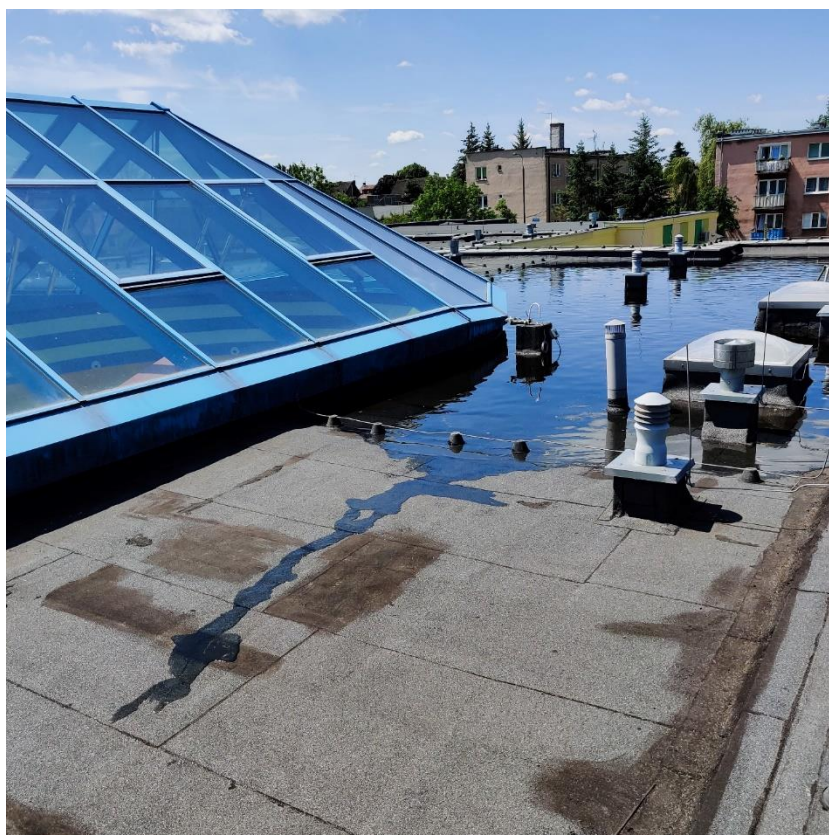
Pierwsza próba obciążeniowa – napętnianie niecki stropodachu.
